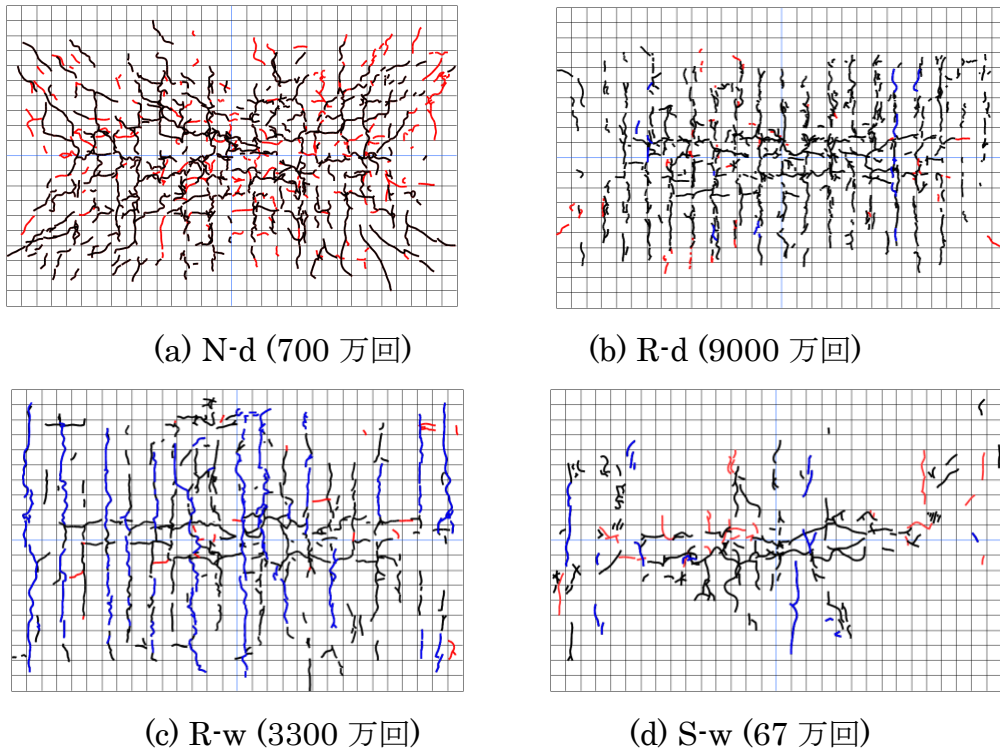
床版下面のひび割れ発生状況(疲労限界状態時)
